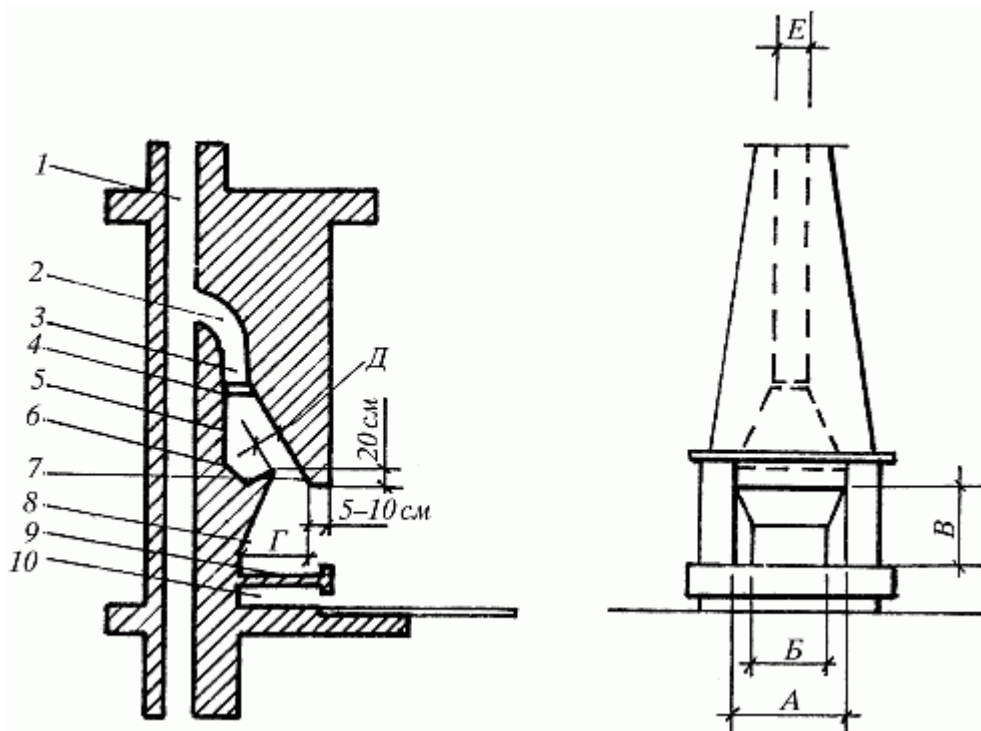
Камин, пристроенный к дымовой трубе: 1 – дымовая труба; 2 – колено; 3 – дымоход; 4 – задвижка; 5 – дымовая камера; 6 – обратное днище; 7 – стенка; 8 – топка; 9 – днище (под); 10 – зольник; А – ширина топки; В – задняя стенка; В – высота топки; Г – глубина топки; Д – дымовое отверстие (горловина); Е – дымовая труба
